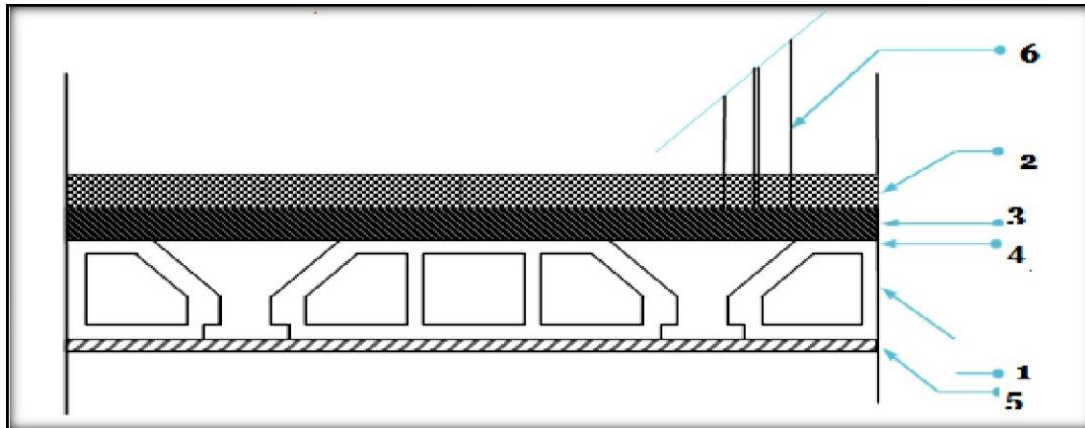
coupe transversale au niveau de plancher terrasse inaccessible.
